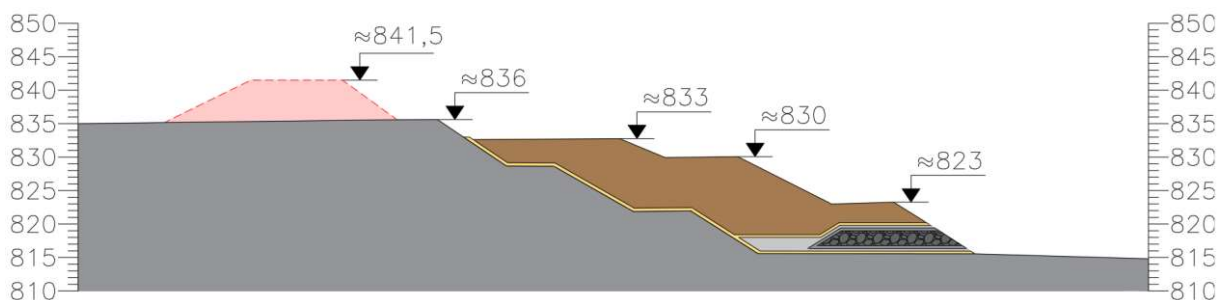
Seção Tipo da escavação dos alteamentos de montante da Barragem B1
